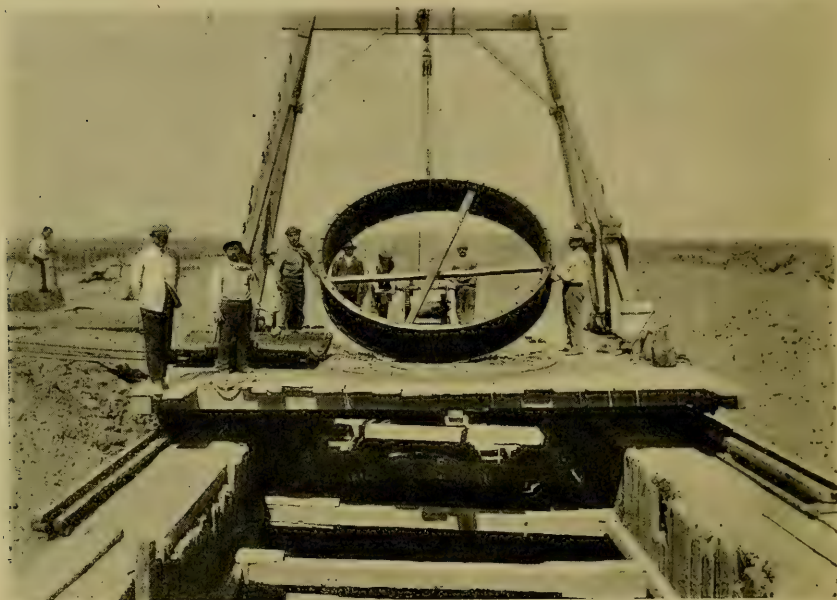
Sección terrestre. Colocación de un anillo de hierro fundido
